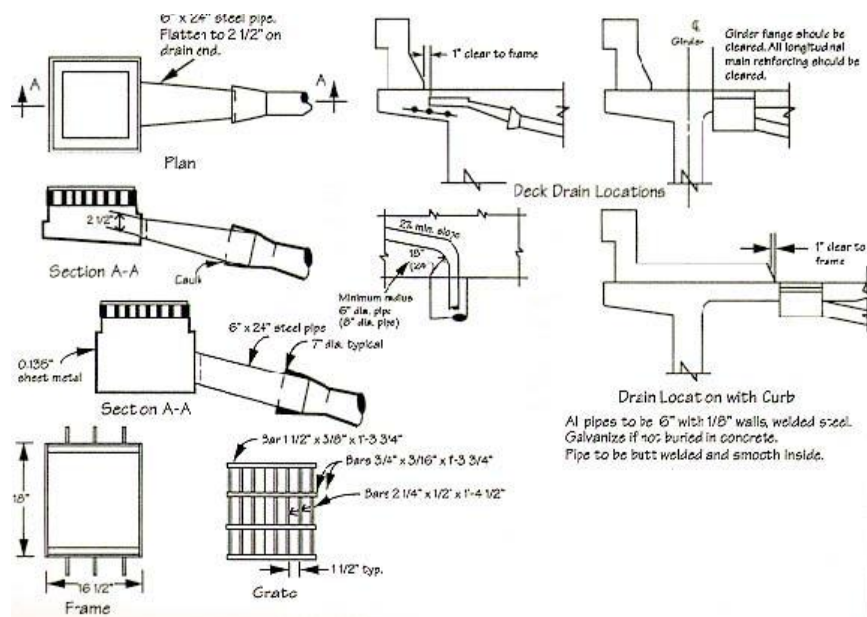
Einlauffassen aus geschweißtem Stahl, Figure 4 in [23]
